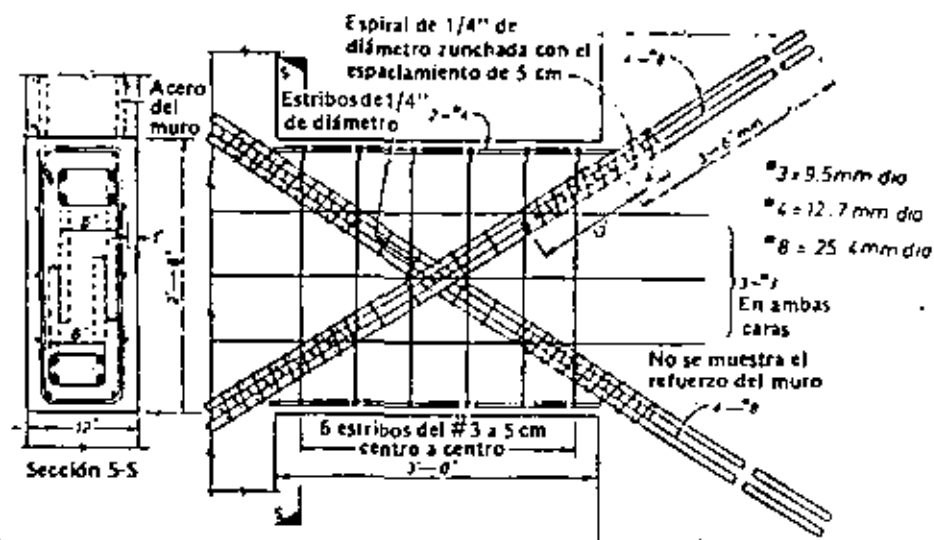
Sugerencia para la disposición del acero en una viga de acoplamiento con refuerzo en diagonal.
